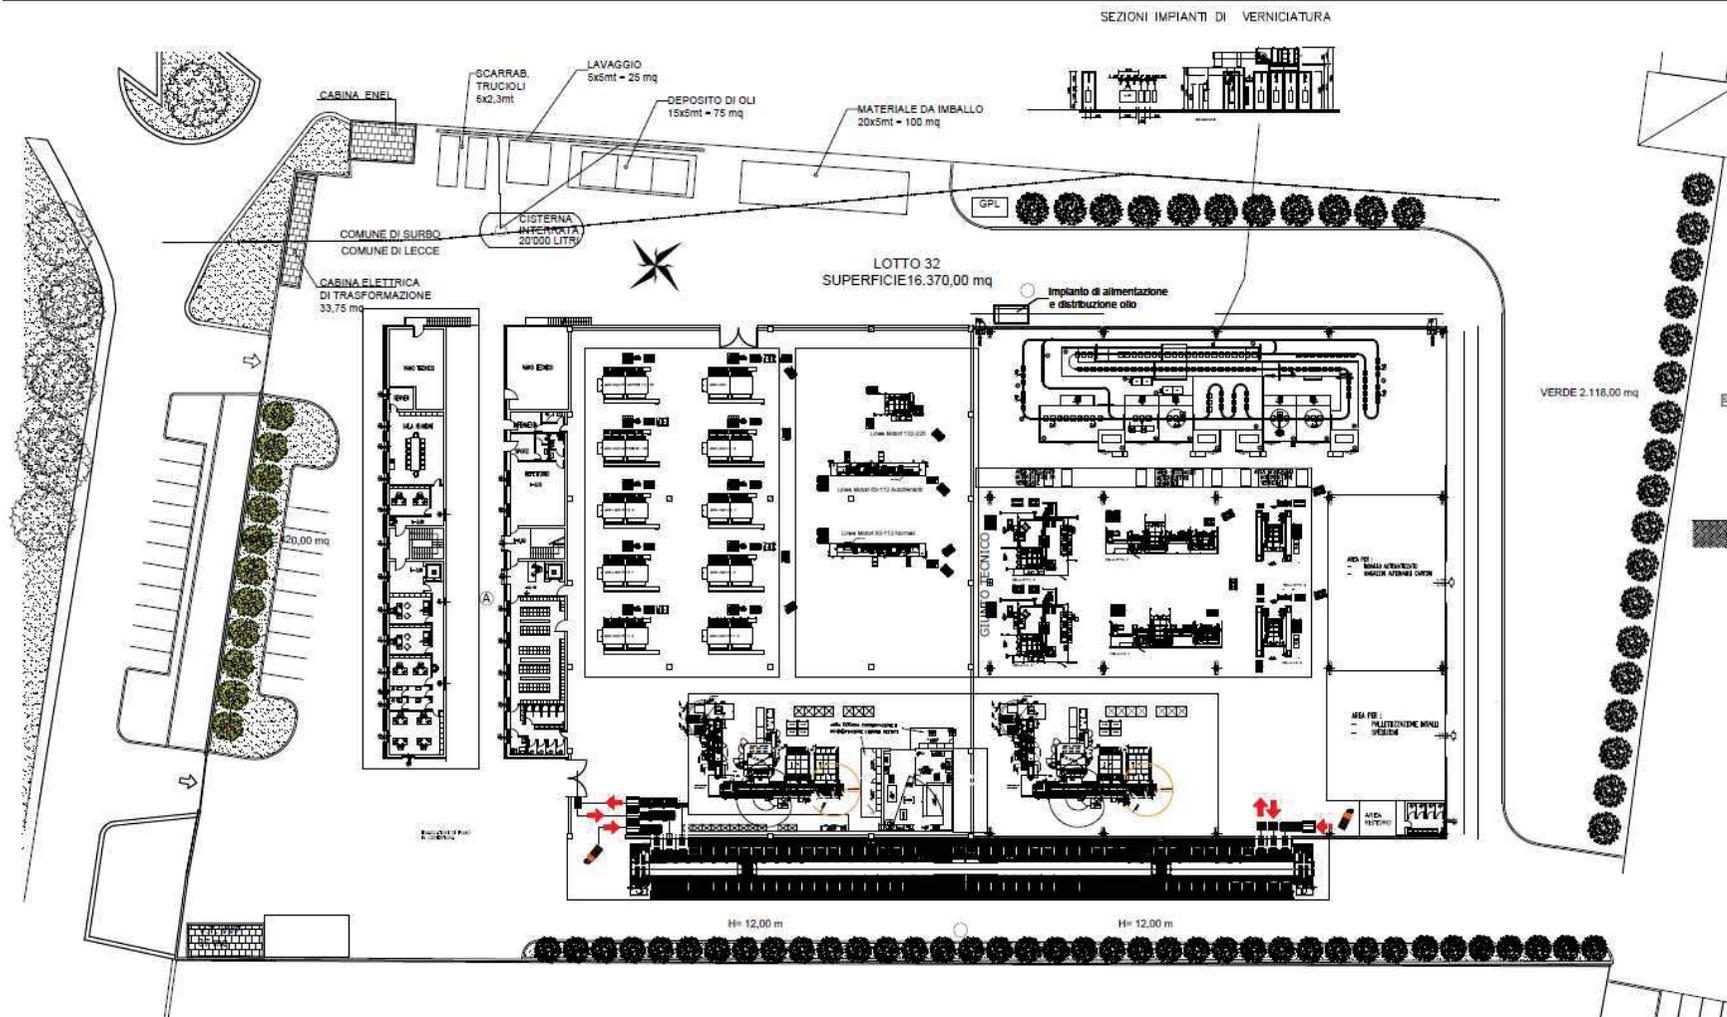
Planimetria di progetto nuovo sito Rossi spA
